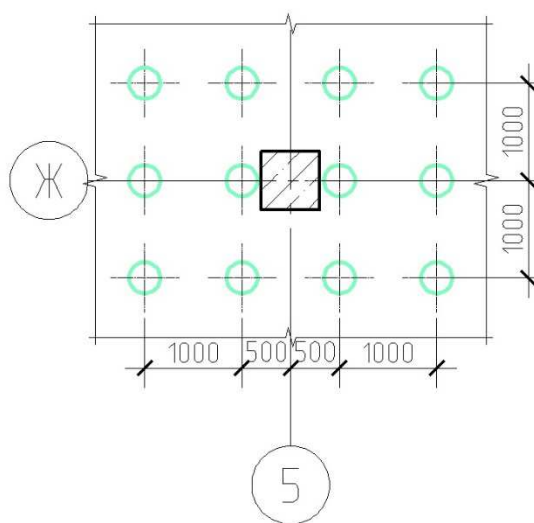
Схема расположения свай под внутреннюю стену
